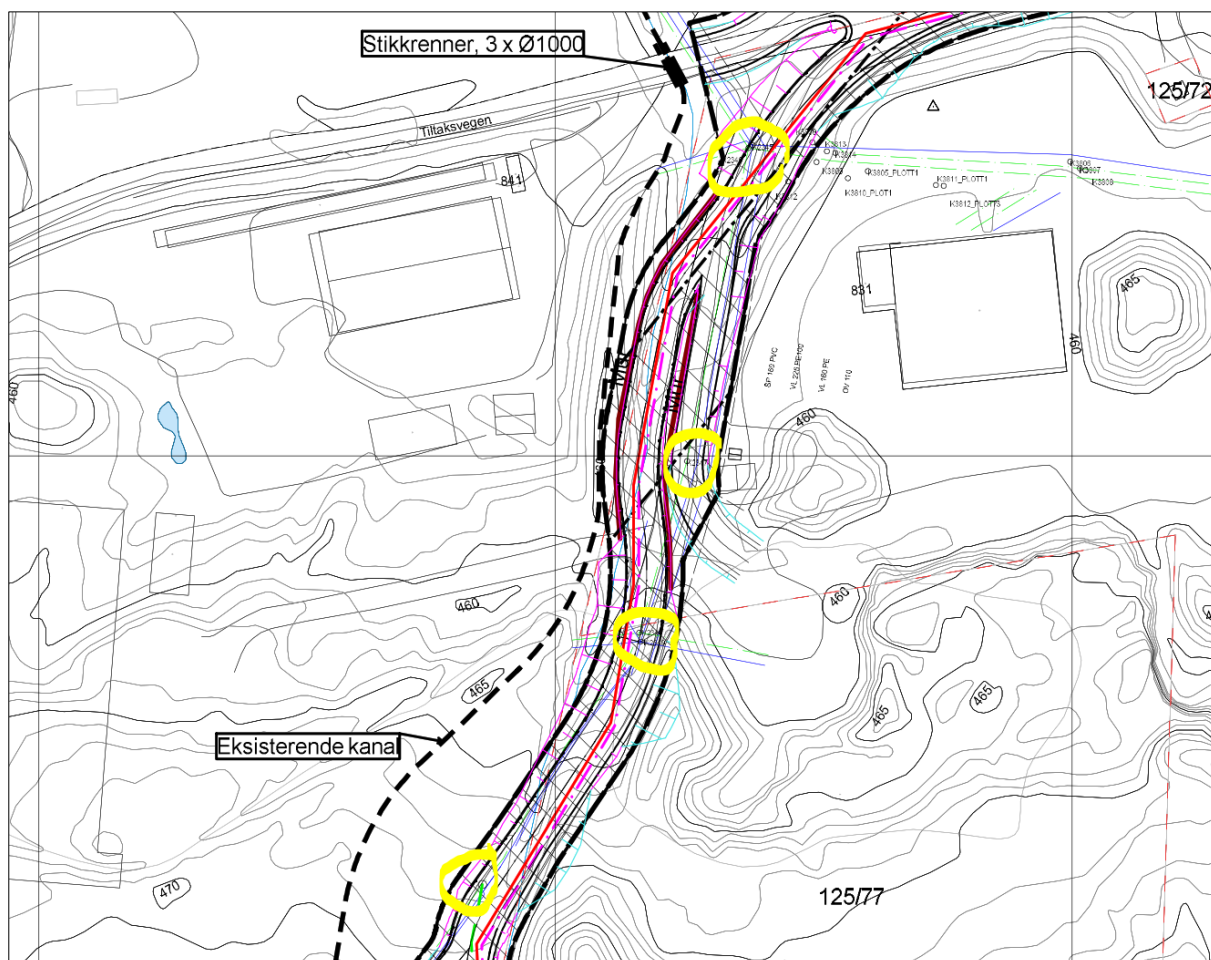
Det planlegges montert samme løsning for uttak av vann til planområdet, utsnitt fra tegning HB101.
